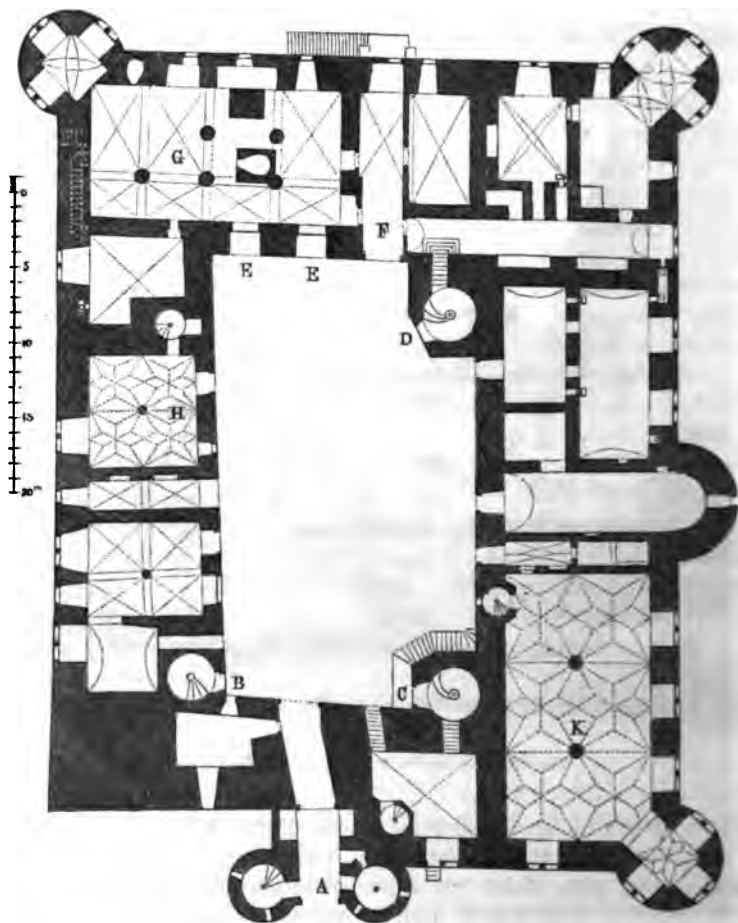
Schloss zu Neuenstein. Grundriss des Erdgeschosses.
